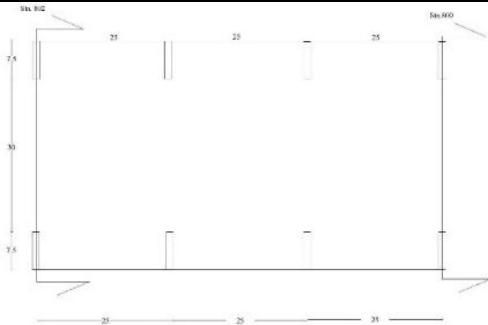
Potongan Memanjang Krib Beton pada Sta. 800
